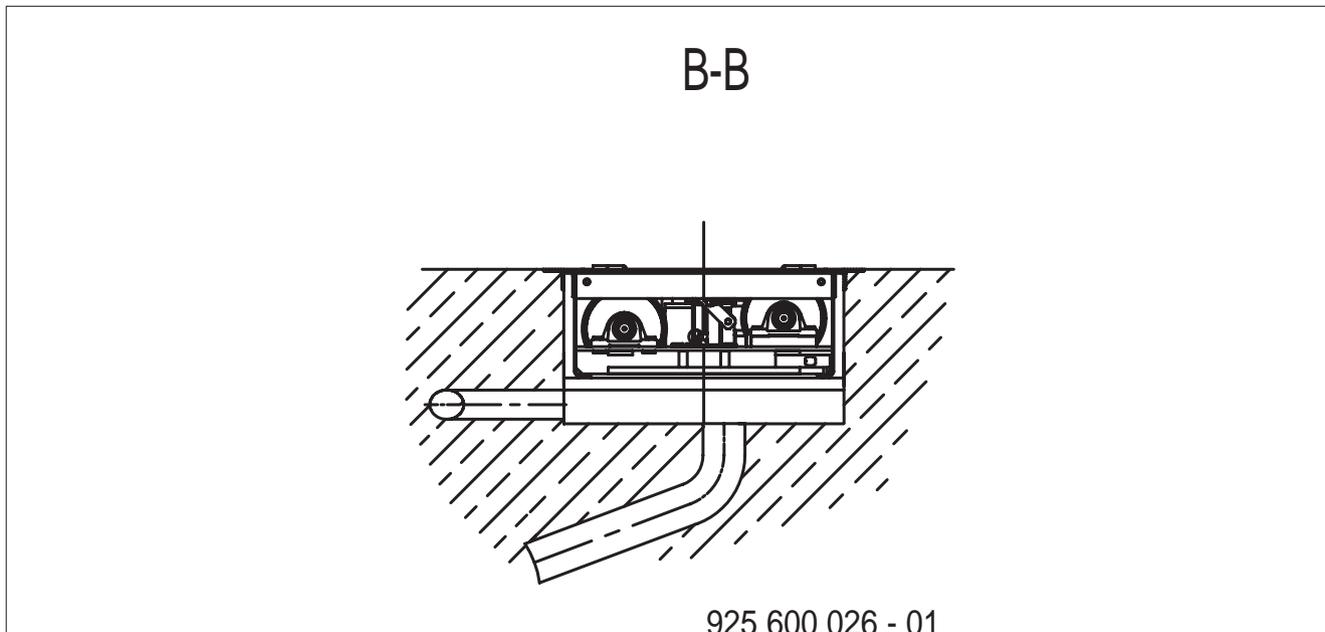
Installationsplan BD 6xx mit Wandhalterung - Schnitt B-B
